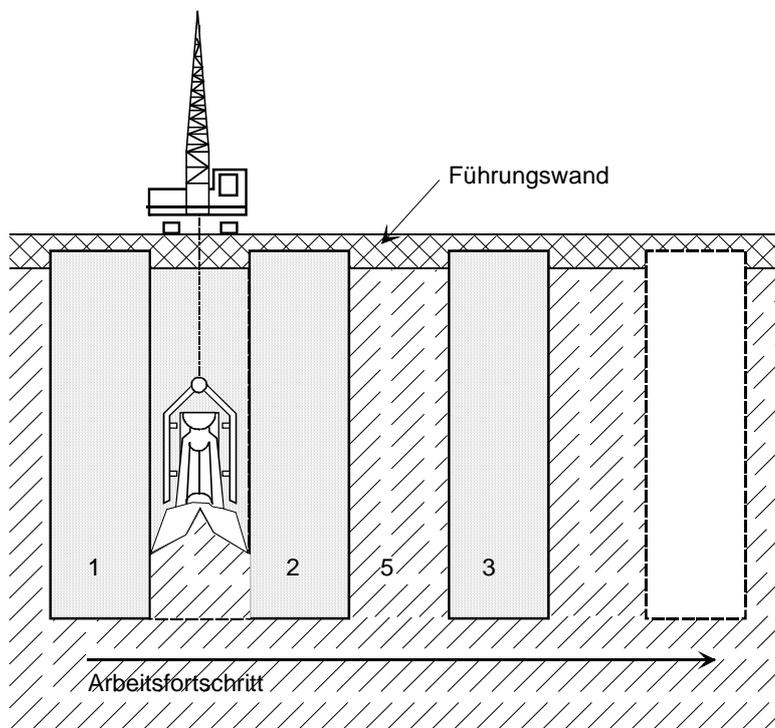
Dichtungsschlitzwand im Einmassenverfahren
